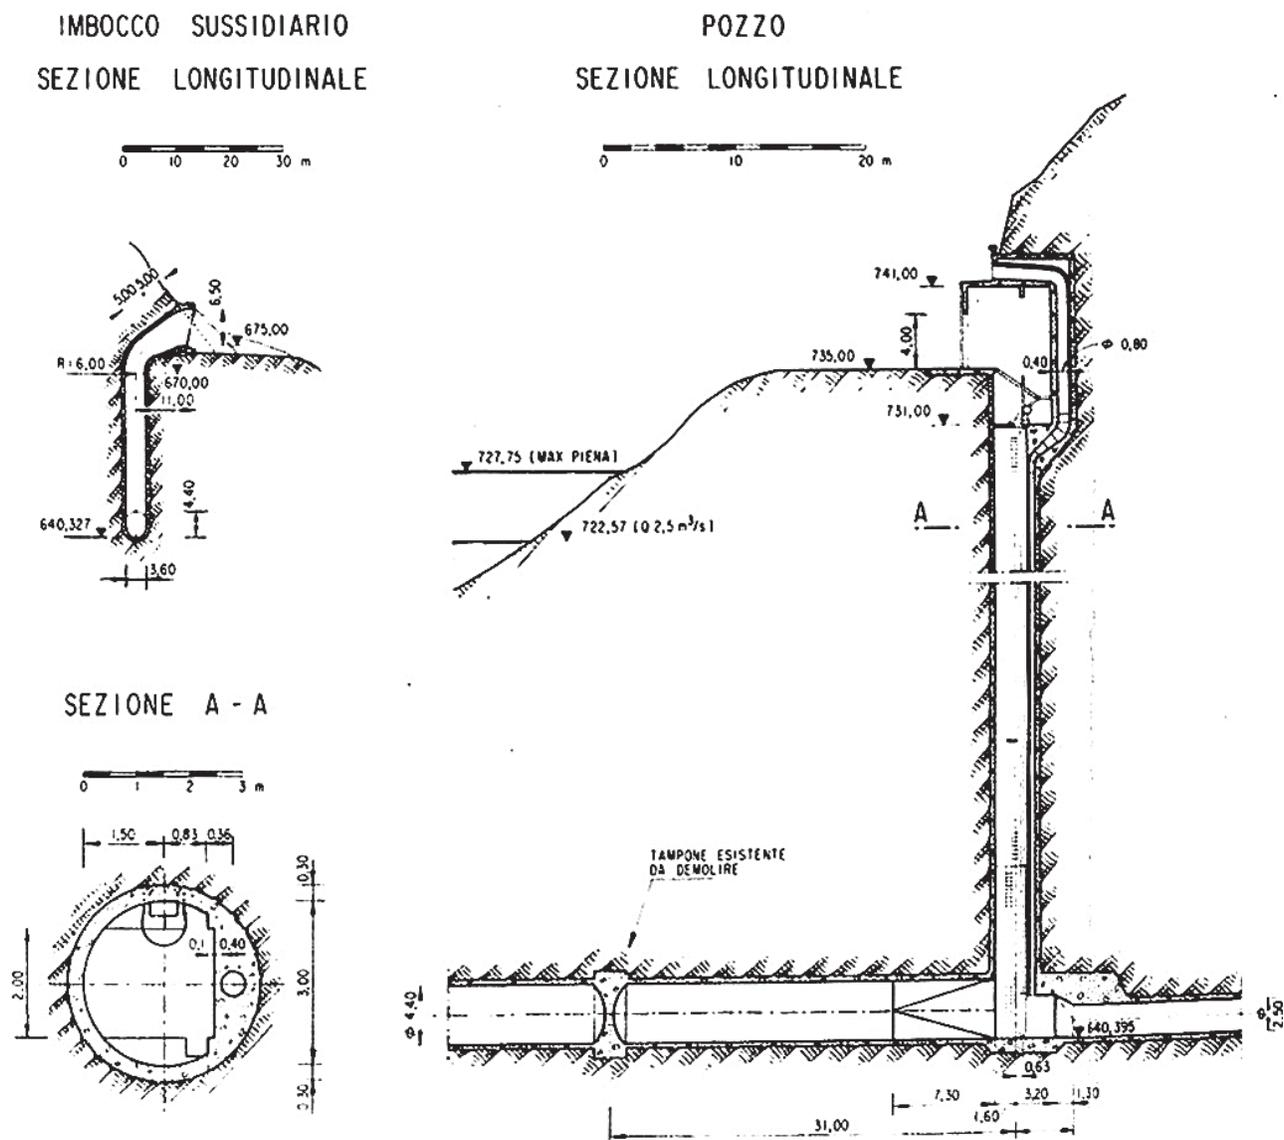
Sezione del pozzo-paratoia e dell'imbocco ausiliario della galleria di scarico di quota 640 m s.l.m. (archivio Progetto Dighe).
